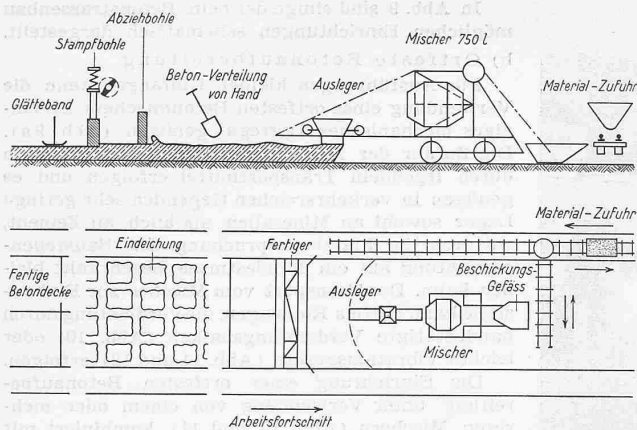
Schema einer fahrbaren Einrichtung für einschichtigen Bau
